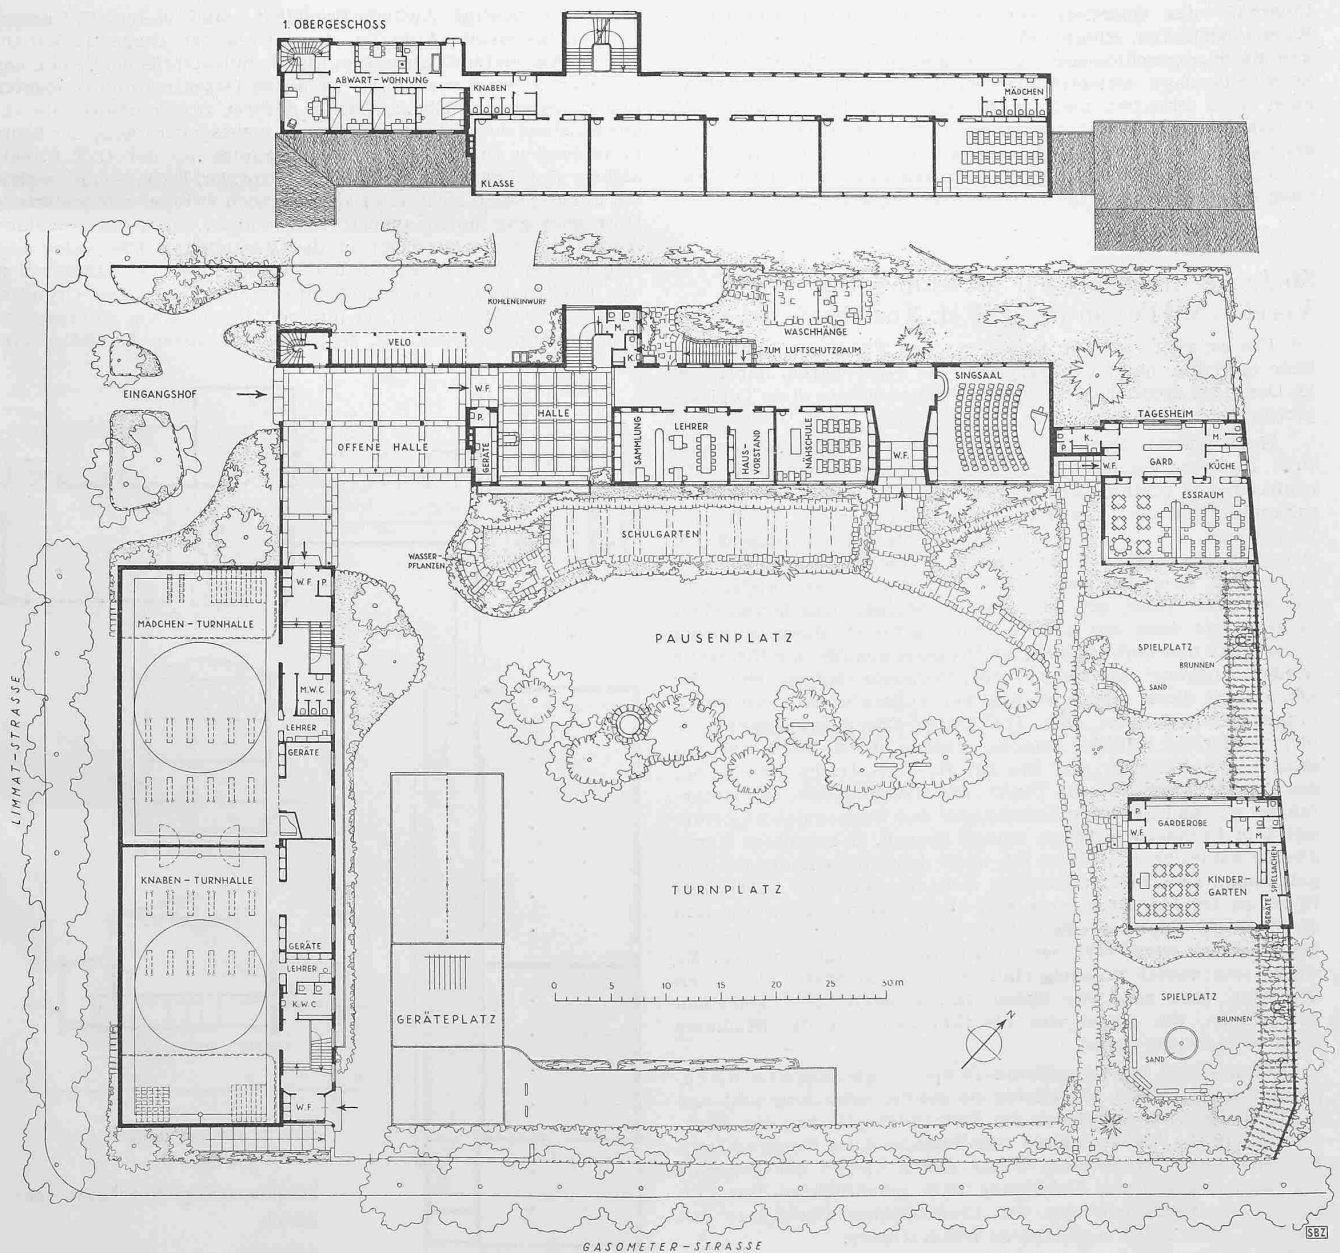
Grundriss 1:600 der Schulhausanlage Kornhausbrücke in Zürich. Architekt Stadtbaumeister A. H. STEINER
